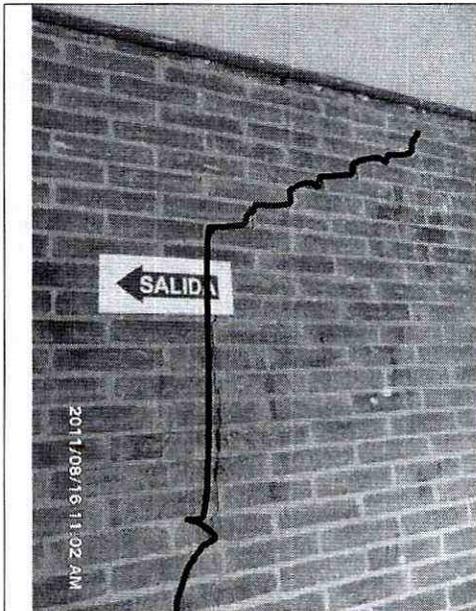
Fisuras presentadas en elementos no estructurales del edificio del lado norte
